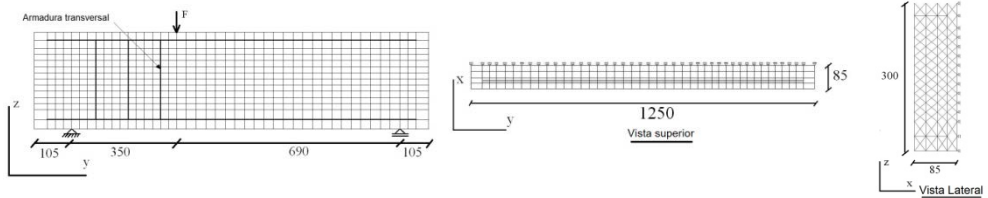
Geometria, malha e condições de apoio da viga SB-C (dimensões em mm)
